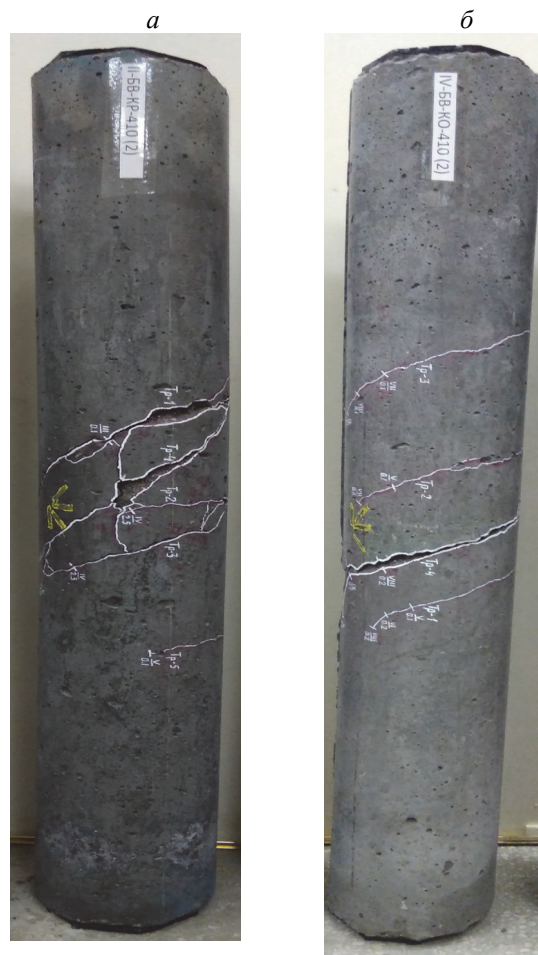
Картина образования и развития трещин при проведении испытаний железобетонных конструкций на кручение с изгибом, сторона Б:
